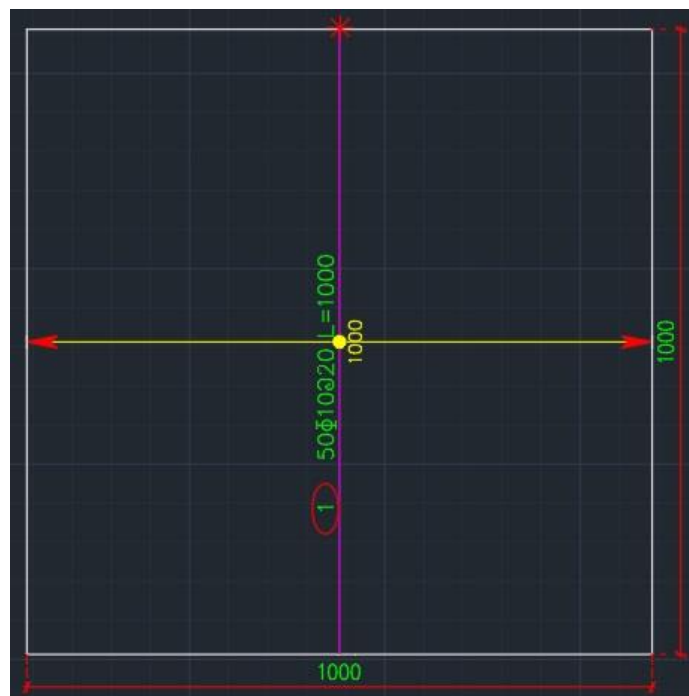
Область 1000x1000 см железобетонной плиты перекрытия после армирования.
